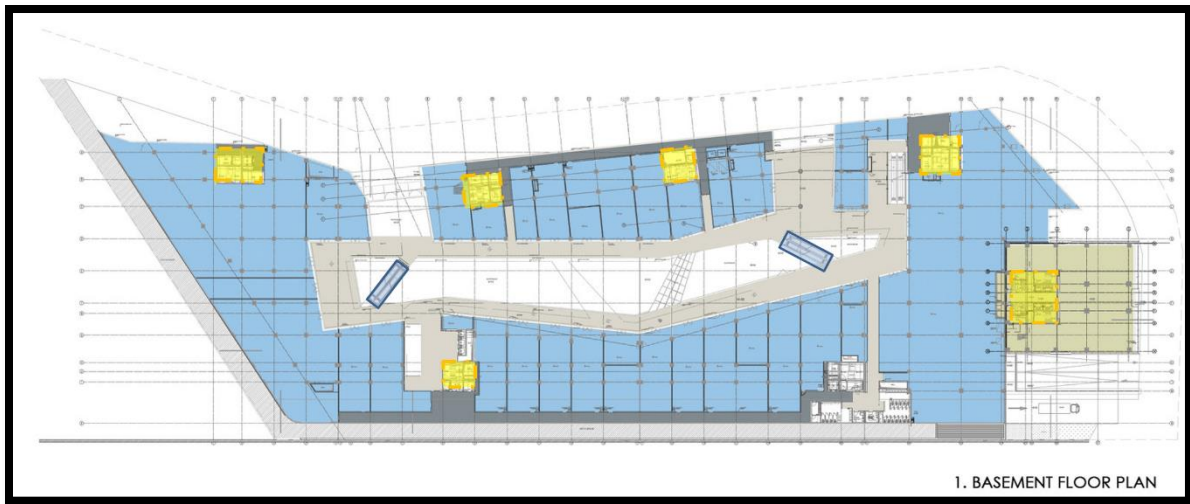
plan rdc représentant les circulations verticale ou horizontal/ Source : <https://www.archdaily.com>, traite par l'auteur
